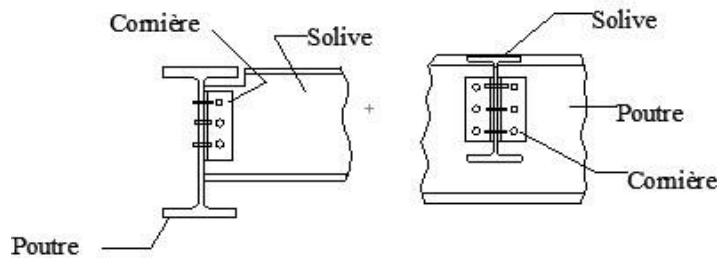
configuration d'un assemblage boulonné par cornières
